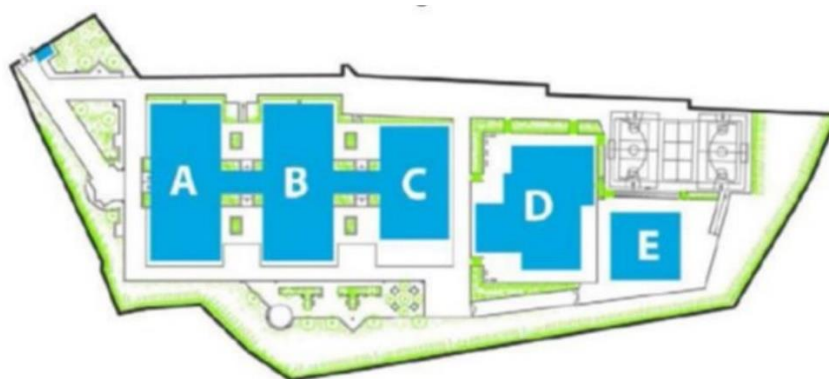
Planta da Escola Secundária Cacilhas-Tejo²
